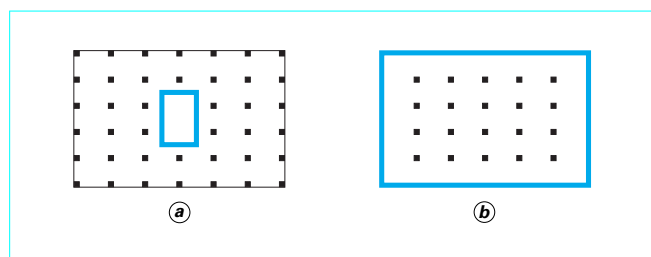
Vues en plan de bâtiments semblables à rayons de torsion différents
